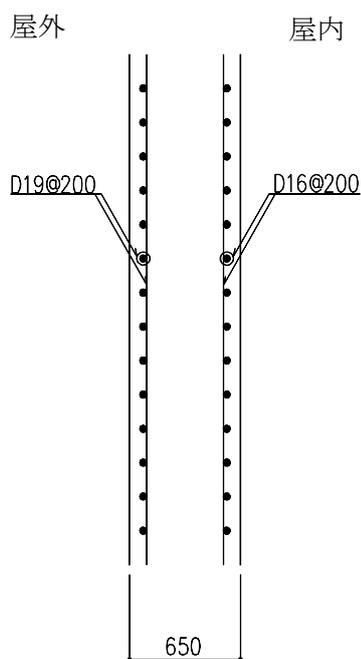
耐震壁の配筋図 (地下1階, YH通り X17~X18 通り間) (単位: mm)
